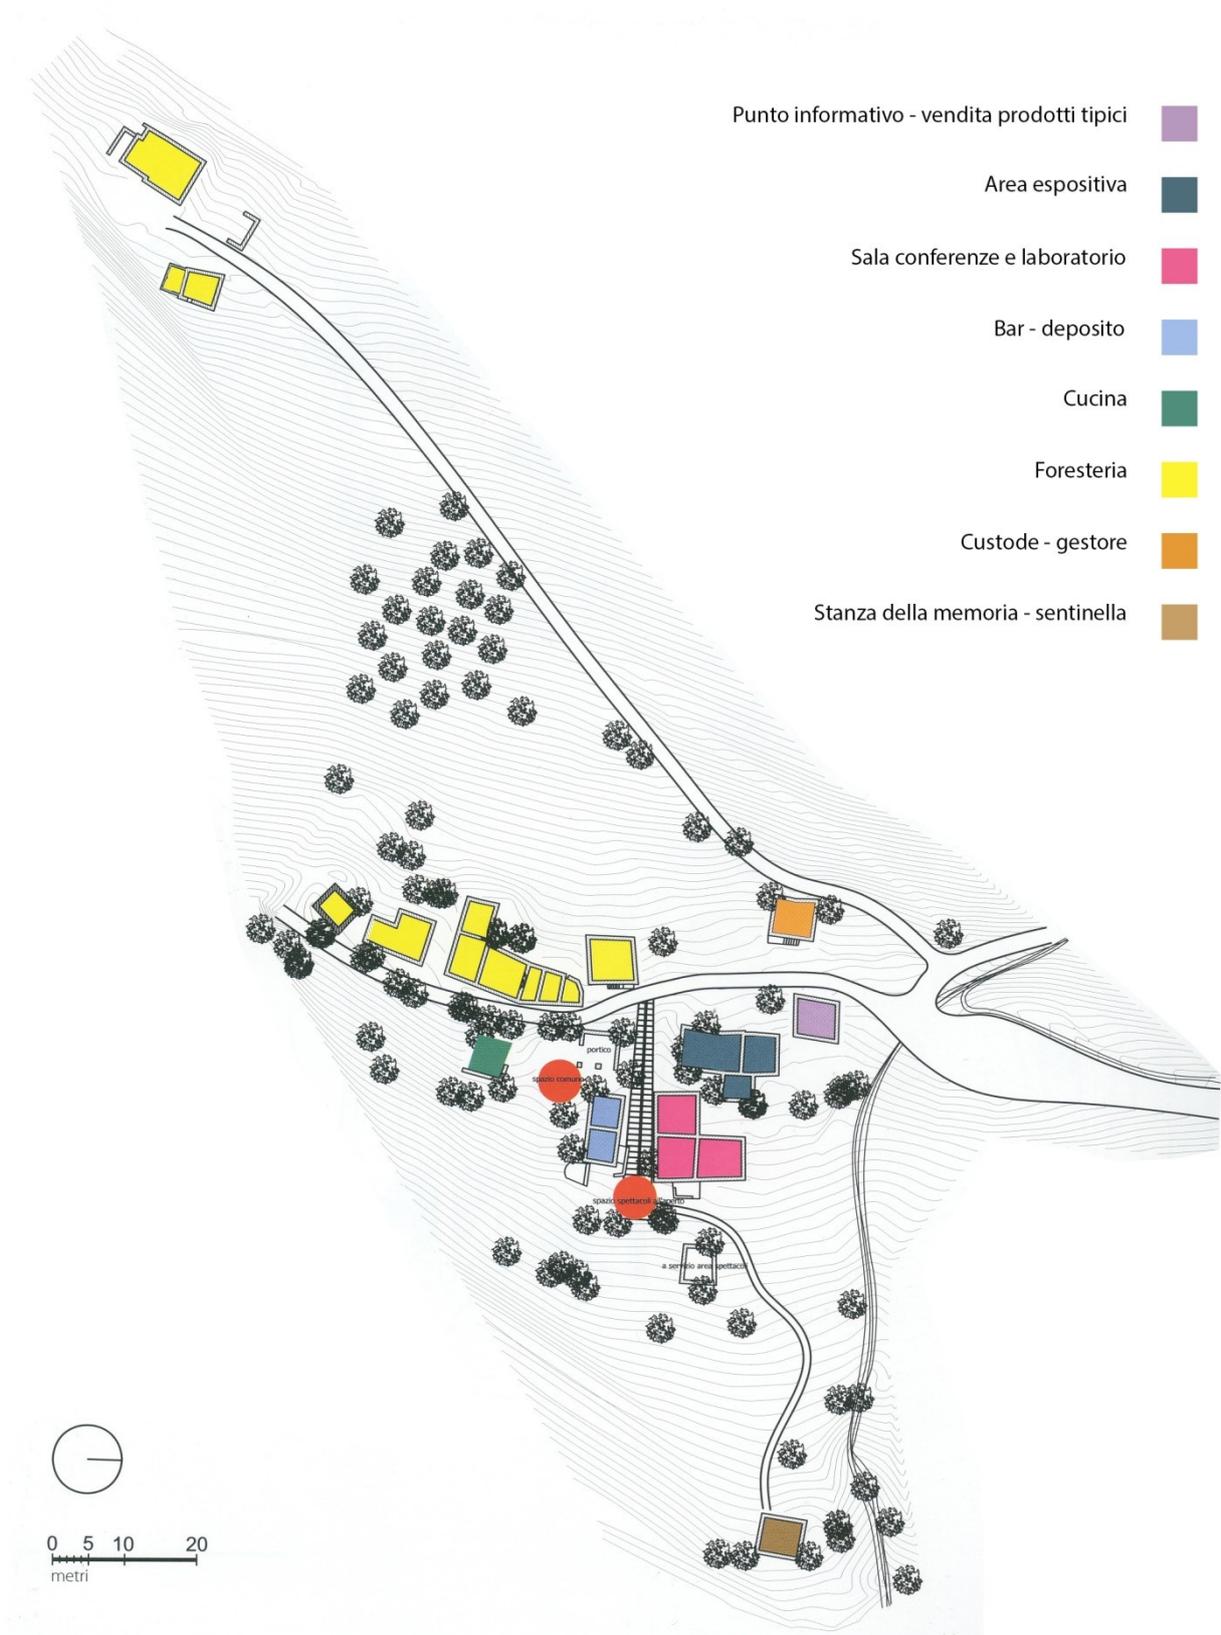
Planimetria del borgo di Paraloup con indicazione delle funzioni previste nel progetto
